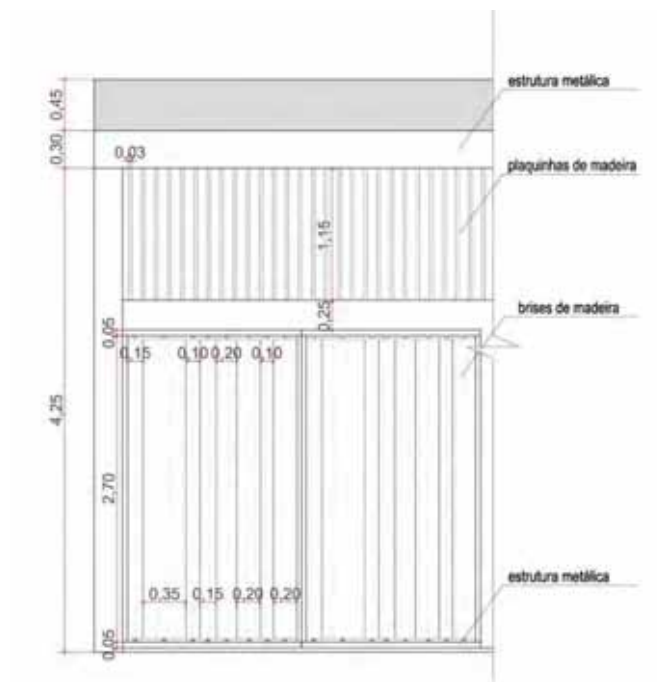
Detalhe brise na fachada Fonte: da autora (2011).
